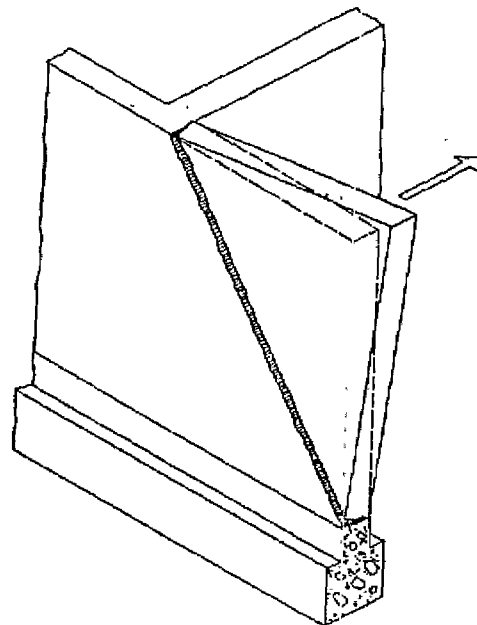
b.-FALLA TIPICA EN FLEXION DE MURO SIN
